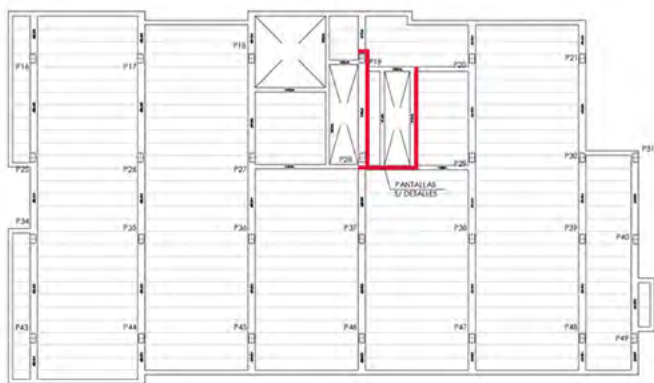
Planta tipo de Milord I (9 plantas) con pantallas de refuerzo.
